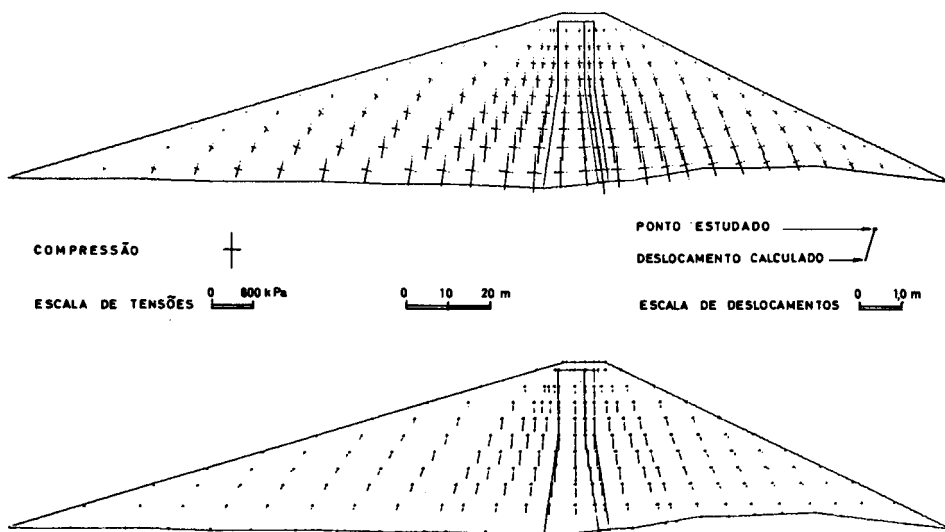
Tensões principais e deslocamentos no final da construção da barragem “Balder” (núcleo lado seco)
